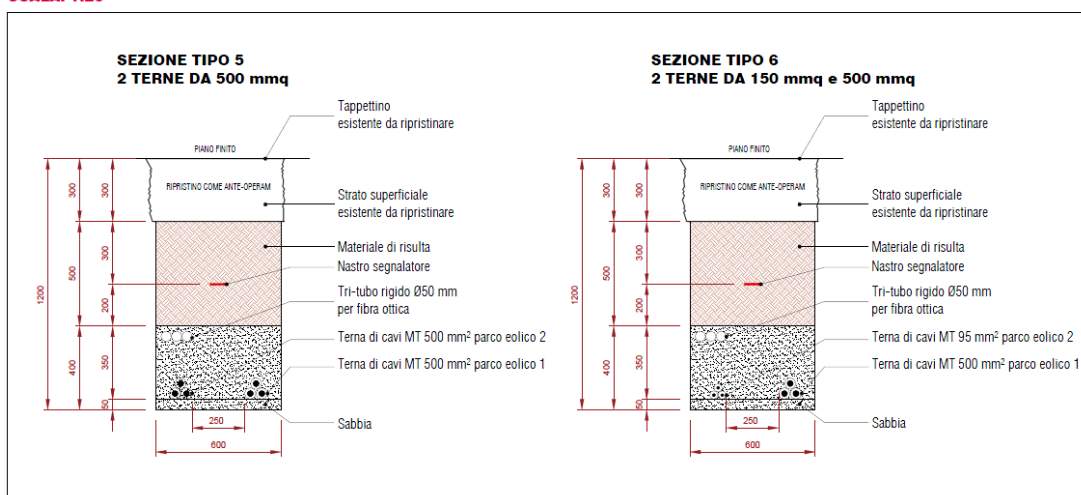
Sezioni tipo di scavo per cavidotto interno al parco eolico
